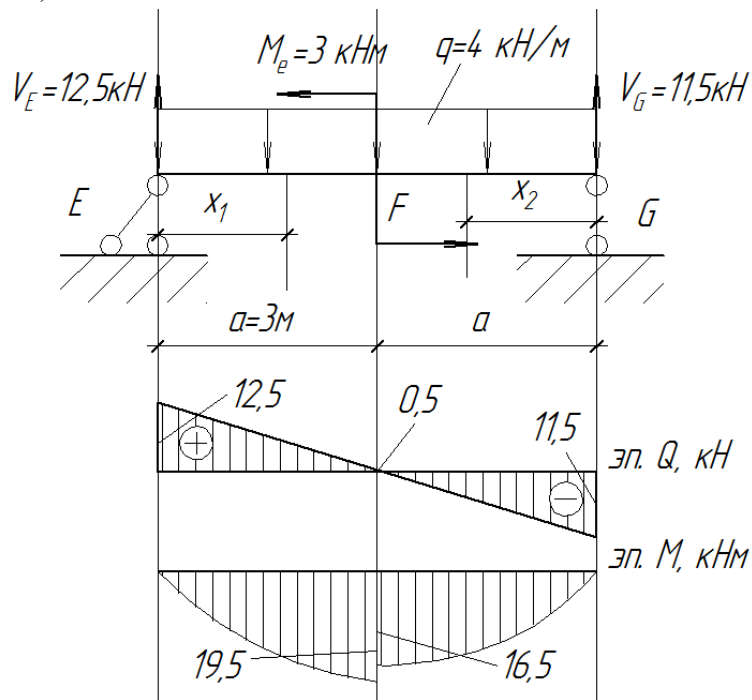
Расчётная схема балки EG второго этажа. Эпюры поперечных сил и изгибающих моментов
